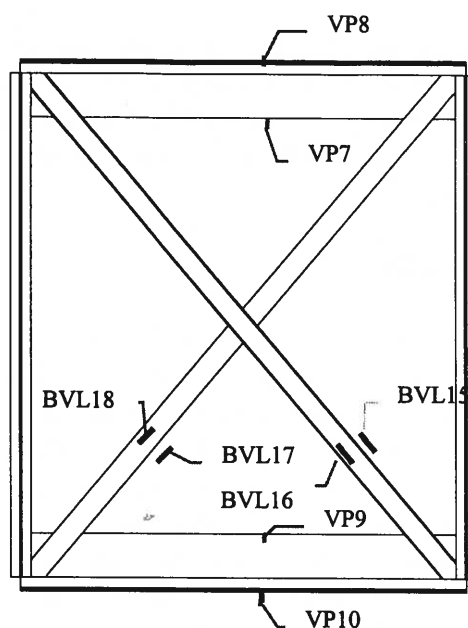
Posição dos extensómetro vista longitudinal vertical, lado da Covilhã. Idêntica à realizada do lado da Guarda.
